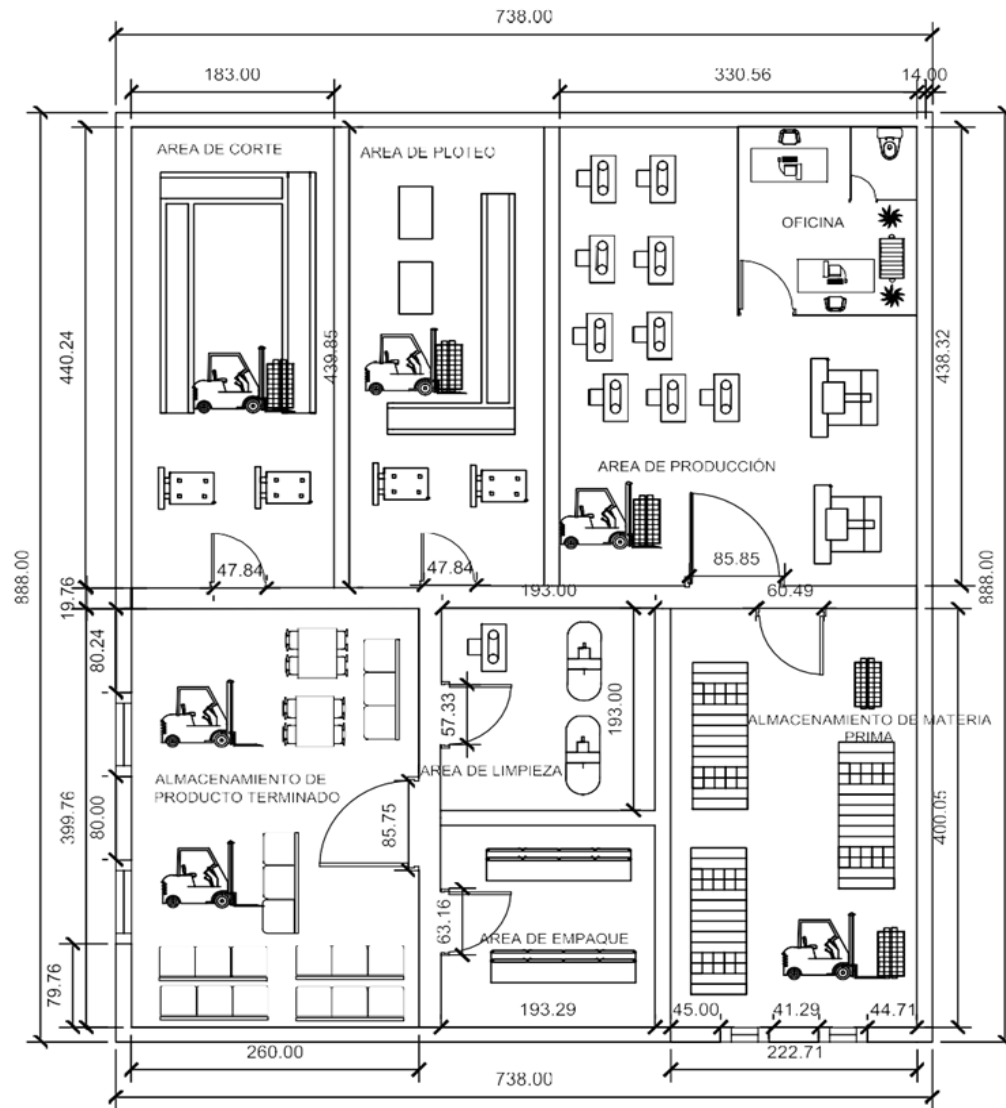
Layout de la empresa Peruvian Sourcing Group.
